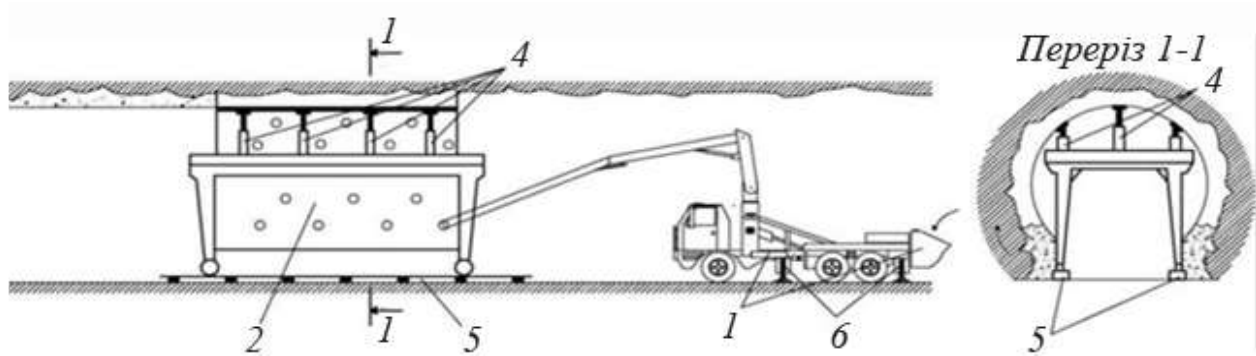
Загальний вигляд бетононасоса, змонтованого на базі автомобіля, і процес бетонування за межами опалубки:
